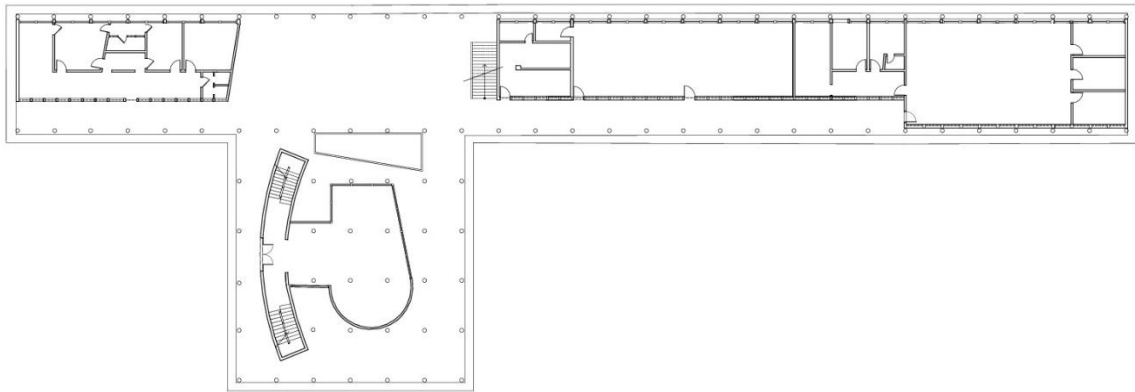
Pavilhão Arthur Neiva: redesenho da planta do 1o pavimento, 1951. Fonte : DAD/COC/Fiocruz
